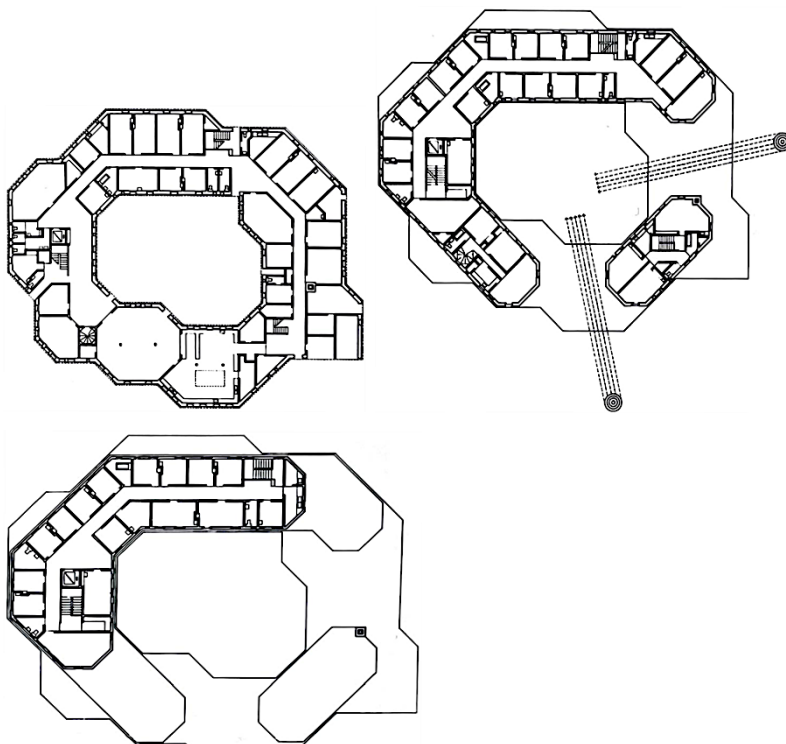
James Stirling, Altenheim Blackheath, Grundrisse EG, 1.OG und 2.OG, 1967, London.
